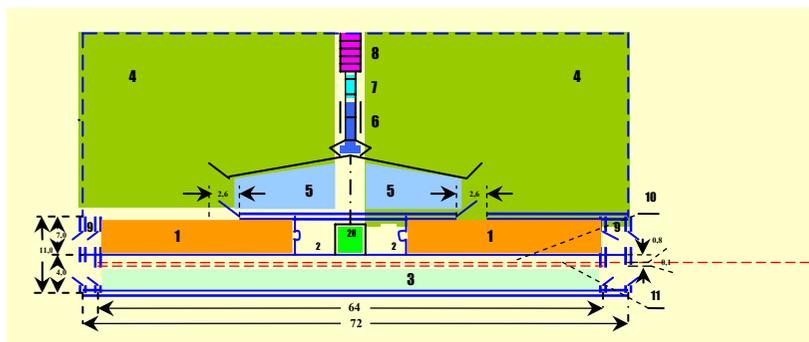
Схема реконструированного помещения для мясного скота под родильное отделение:
